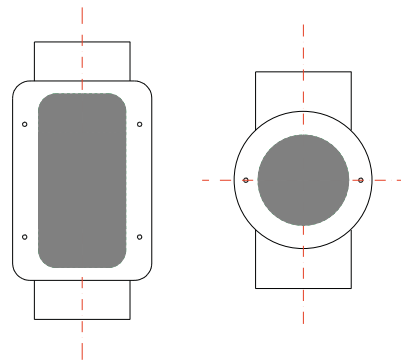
Reinigungsrohre mit rechteckiger bzw. runder Öffnung
